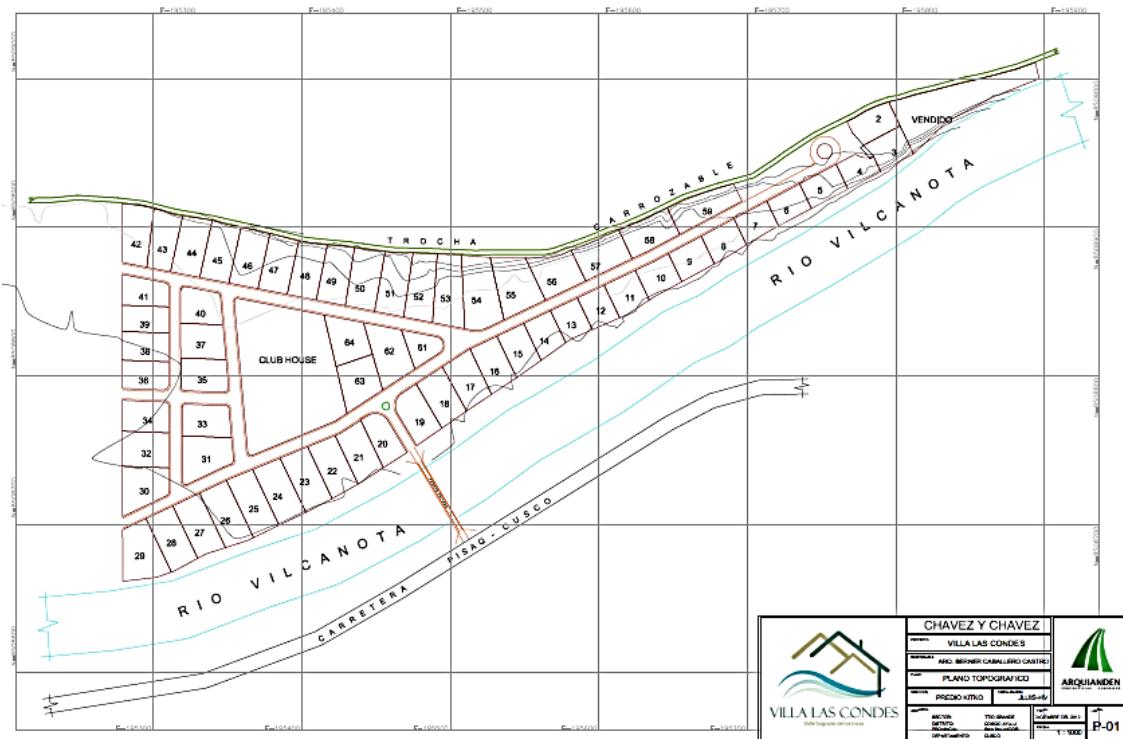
Propuesta anterior del proyecto “Villa las Condes”
